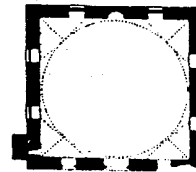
مسقط أفقى لمسجد حاجى
